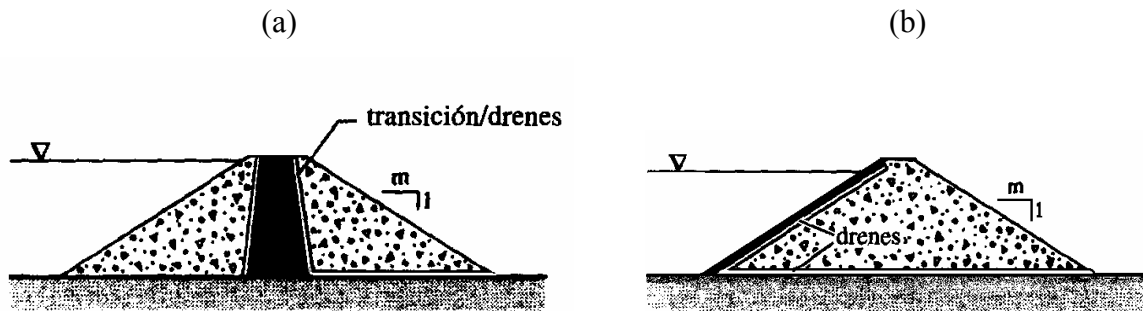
Reducción de la cantidad de infiltración a través de la presa:
